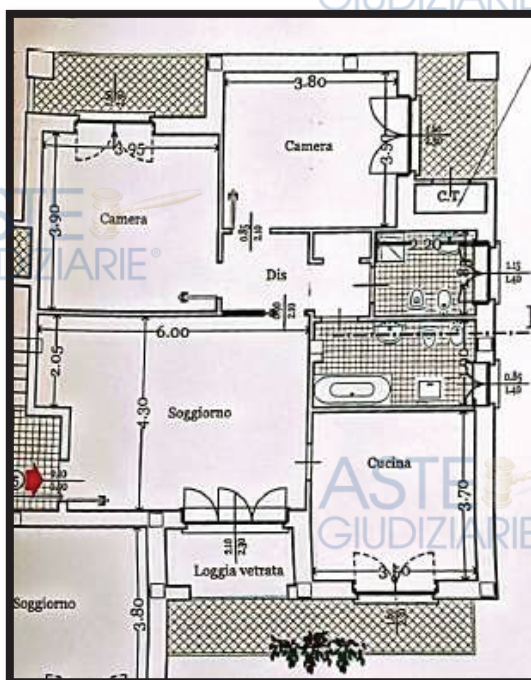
Estratto planimetria piano primo (2° p.f.t.) PdC 226/2004
